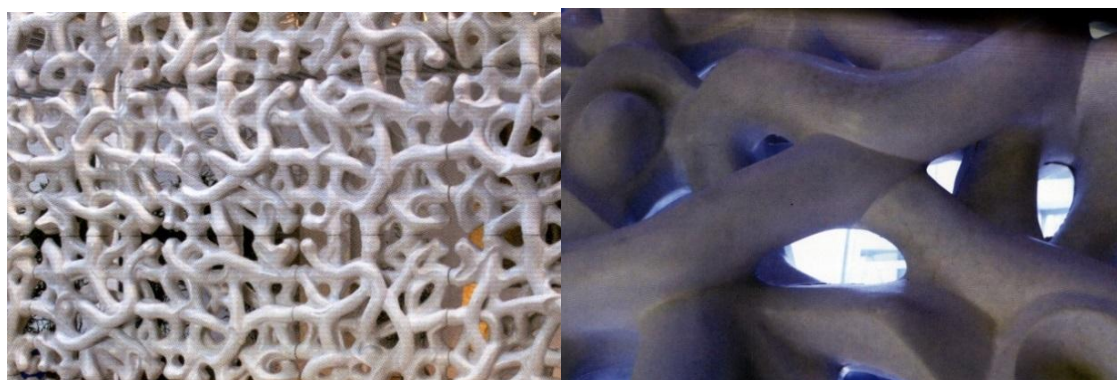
y 47 Celosías de hormigón blanco prefabricadas de la casa Villa Rocca, 2005.
